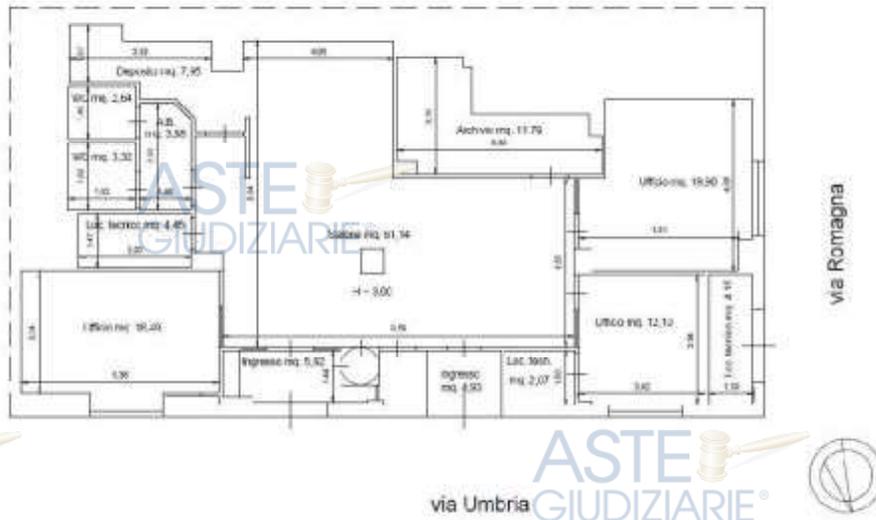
Planimetria rilevata del locale commerciale adibito a filiale di istituto bancario
